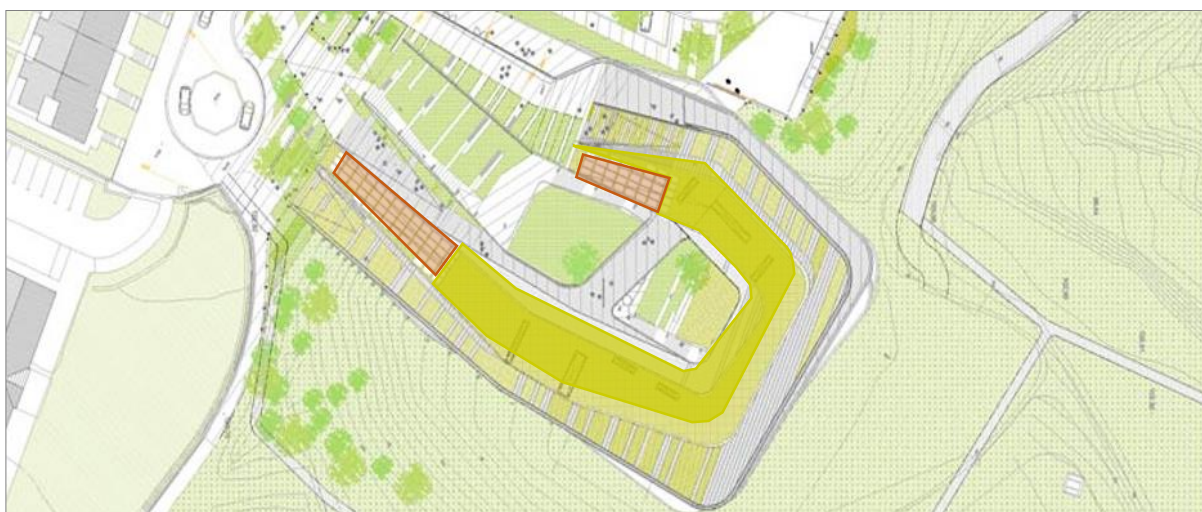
Cubierta (ArchDaily Perú, 2011) Elaboración Propia.
